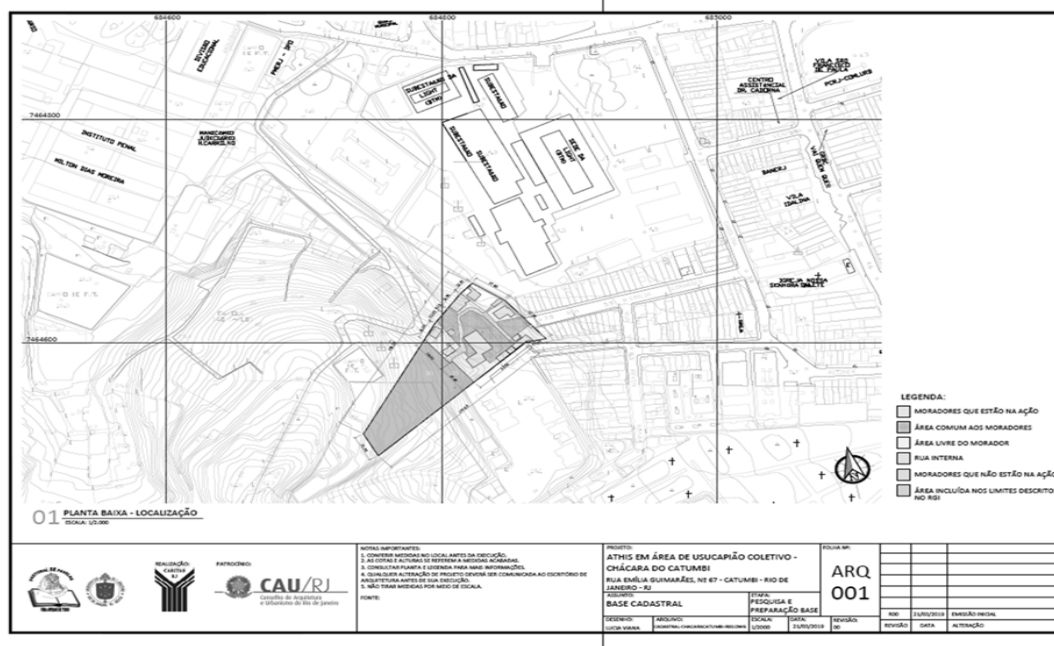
Planta baixa – localização (fonte: acervo da equipe do projeto ATHIS, 2019).
